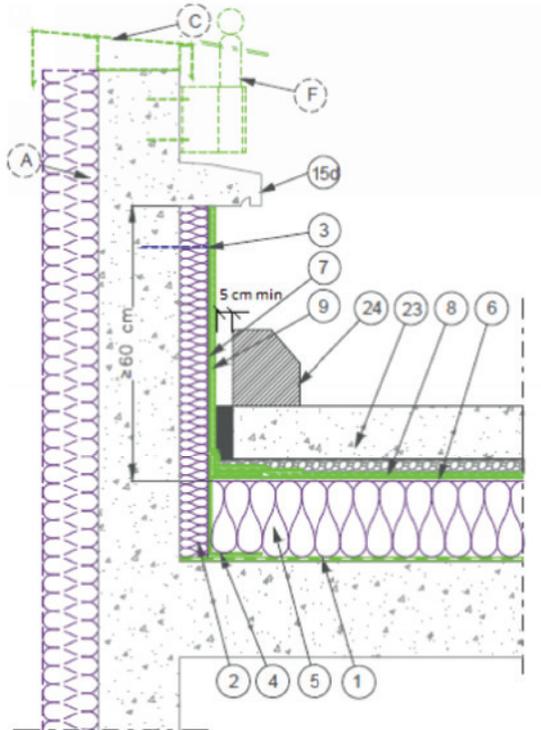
Relevé d'étanchéité sur isolant perlite apte à recevoir un revêtement d'étanchéité bitumineuse soudé
